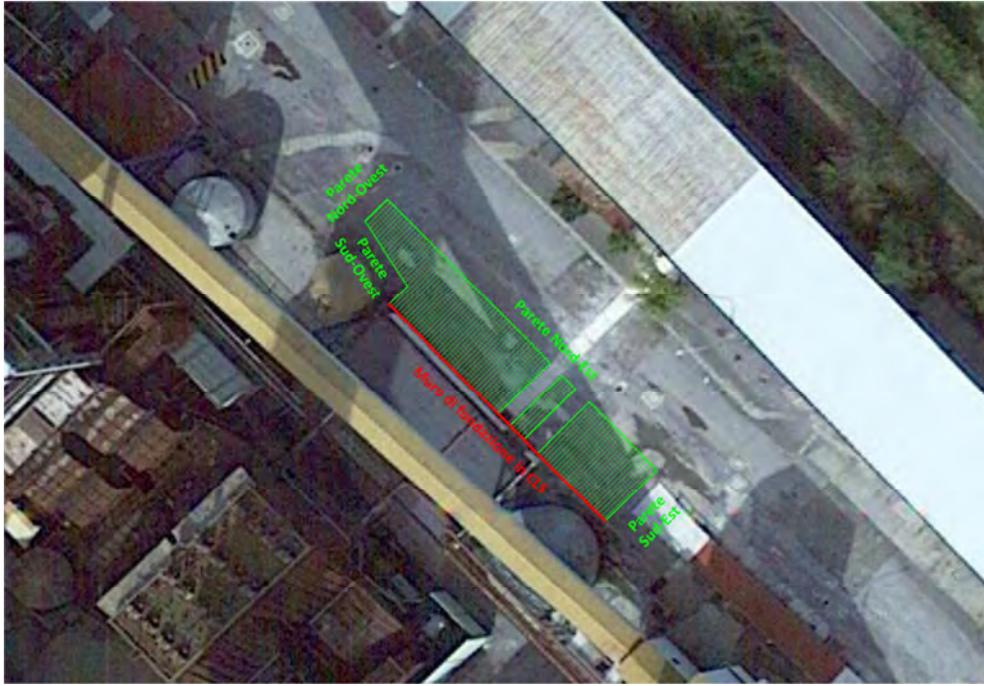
planimetria dello scavo con identificazione delle singole pareti e del muro di fondazione in CLS
